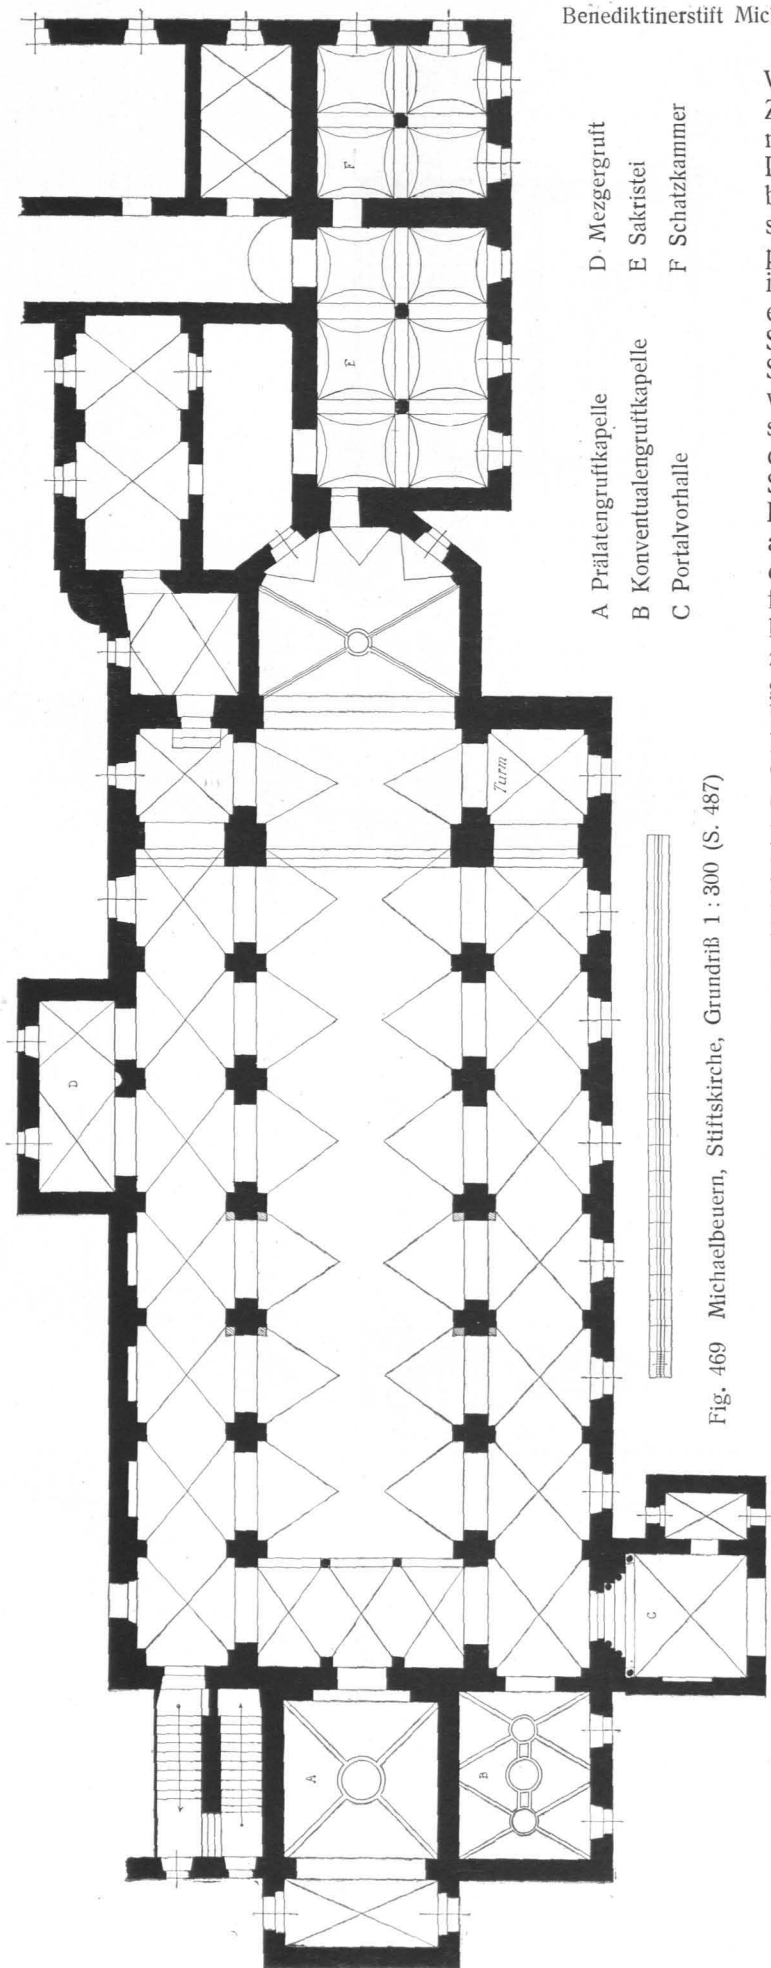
Michaelbeuern, Stiftskirche, Grundriß 1 : 300 (S. 487)
